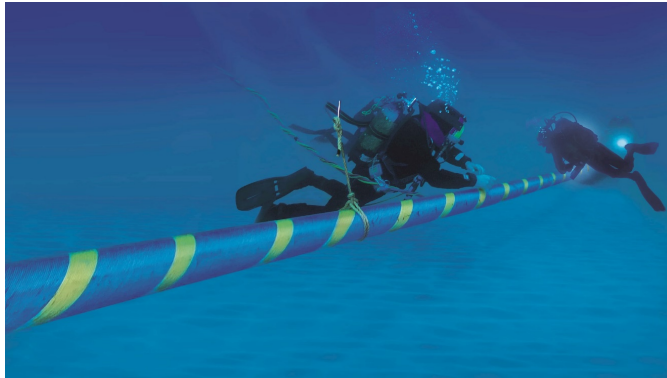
, 11 - Posa del cavidotto marino di collegamento sul fondale e sezione.
